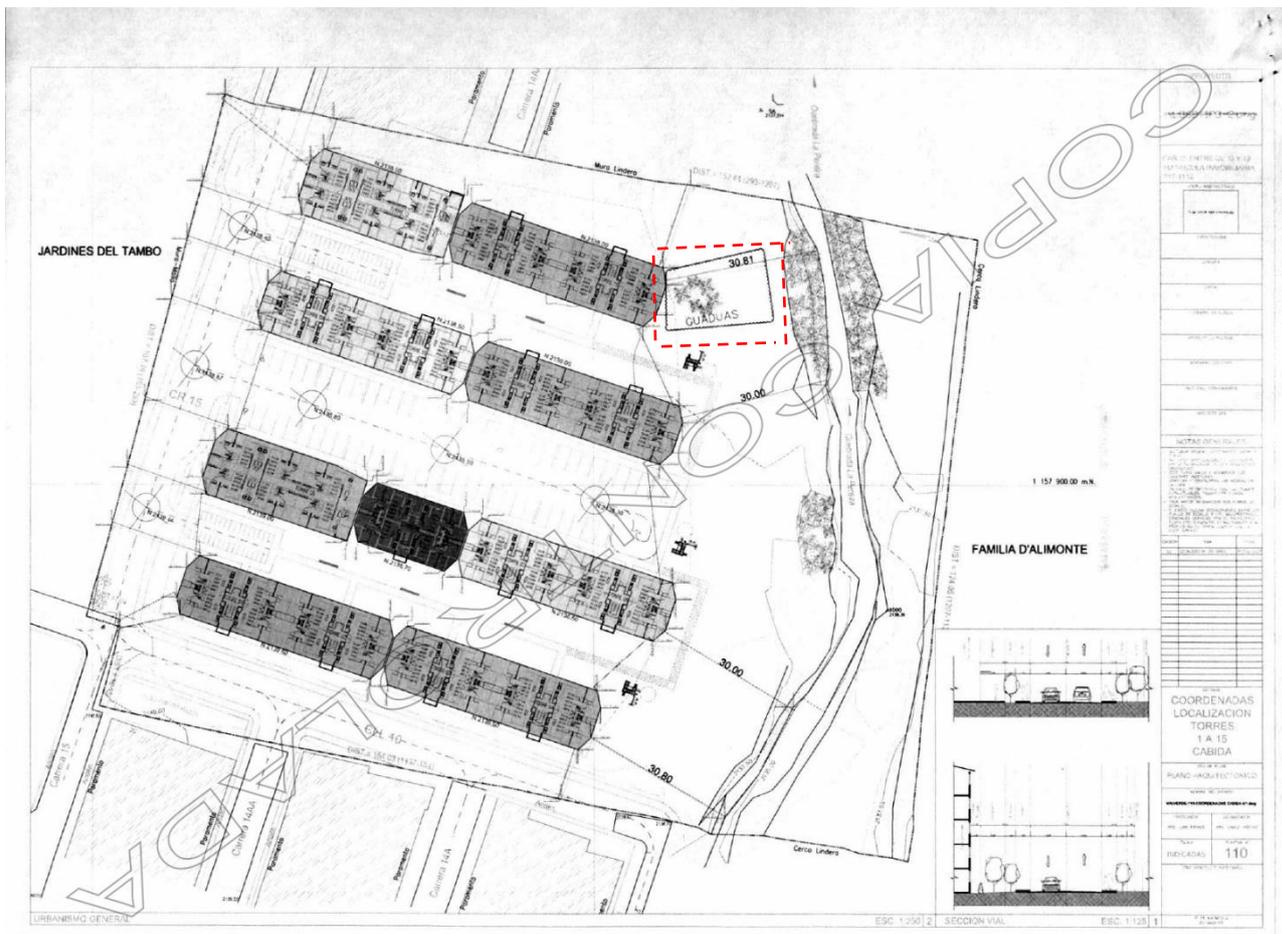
Plano arquitectónico de ubicación del Guadalupe.
